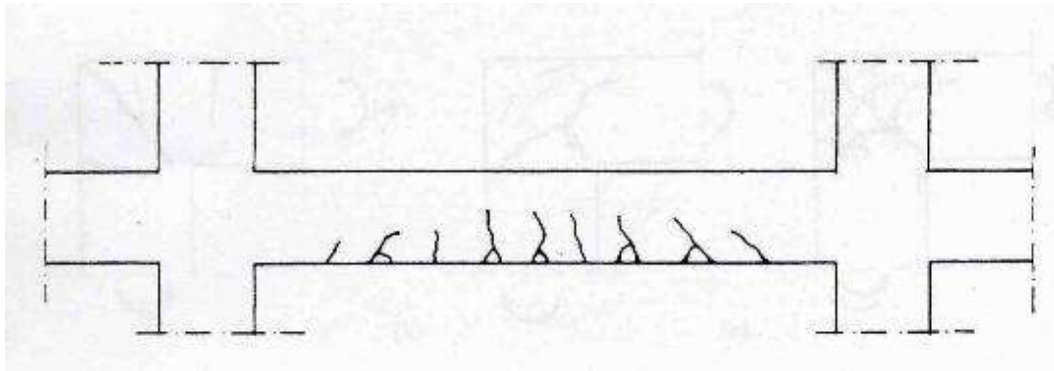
fissures orthogonales sur l'axe de la poutre le long de la travée dans la zone de tendue
